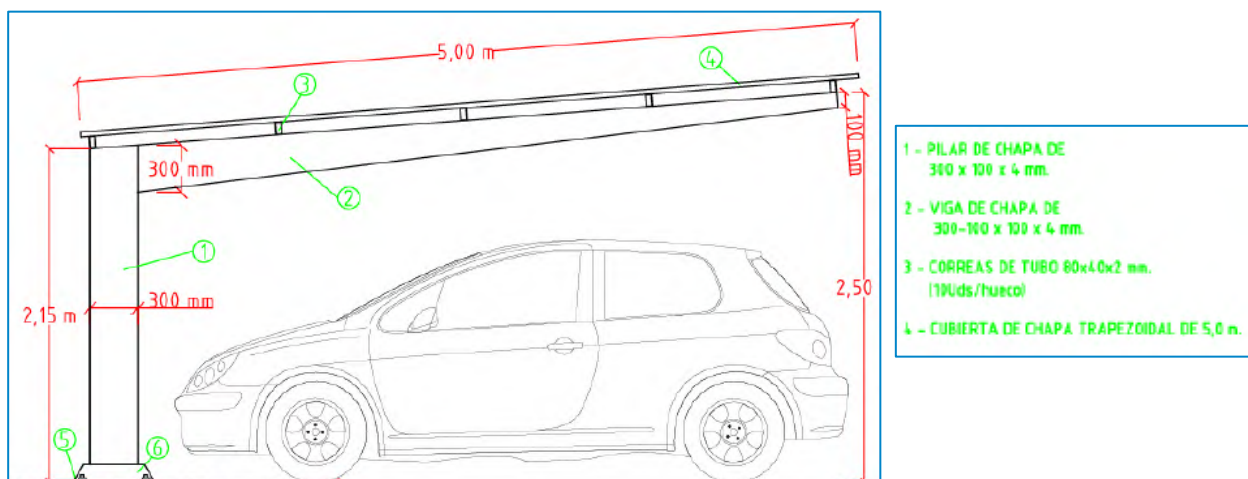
Estructura de montaje de marquesina de aparcamiento
